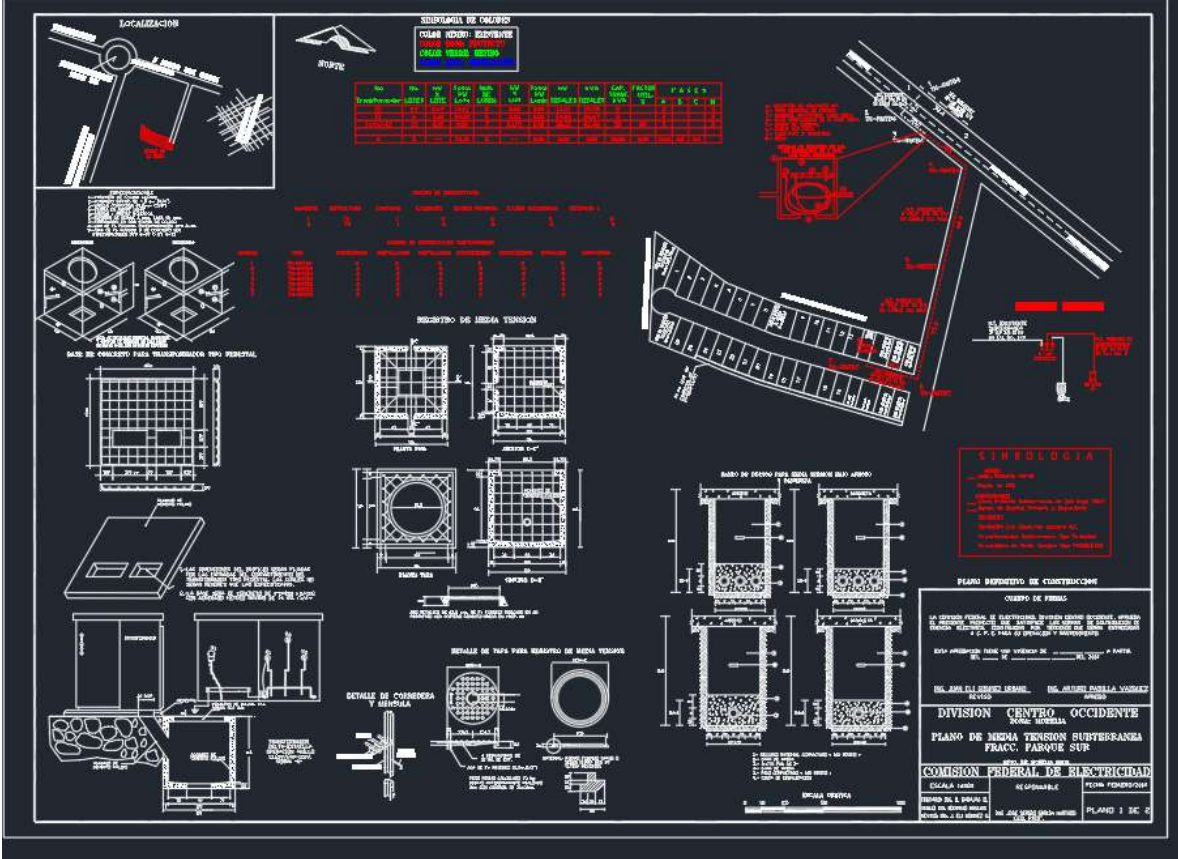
ELEBORACIÓN PLANO DE MEDIA TENSION.
